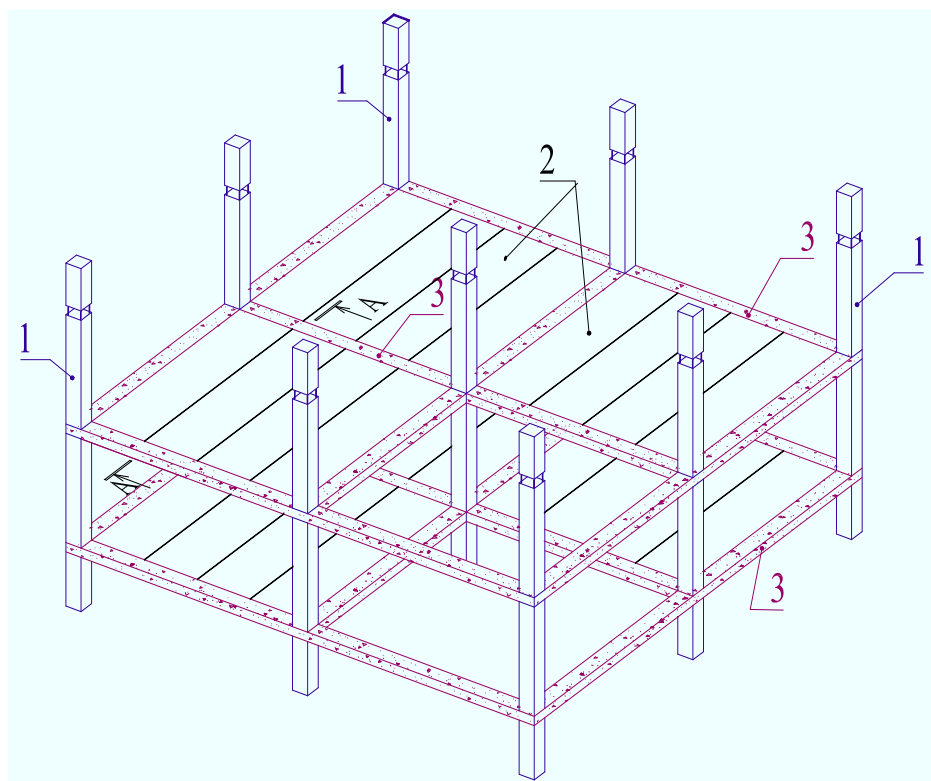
Ескіз збірно-монолітного каркасу 1 - збірні або монолітні колони, 2- збірні багатопустотні плити перекриття, 3 – монолітні бетонні ригелі
